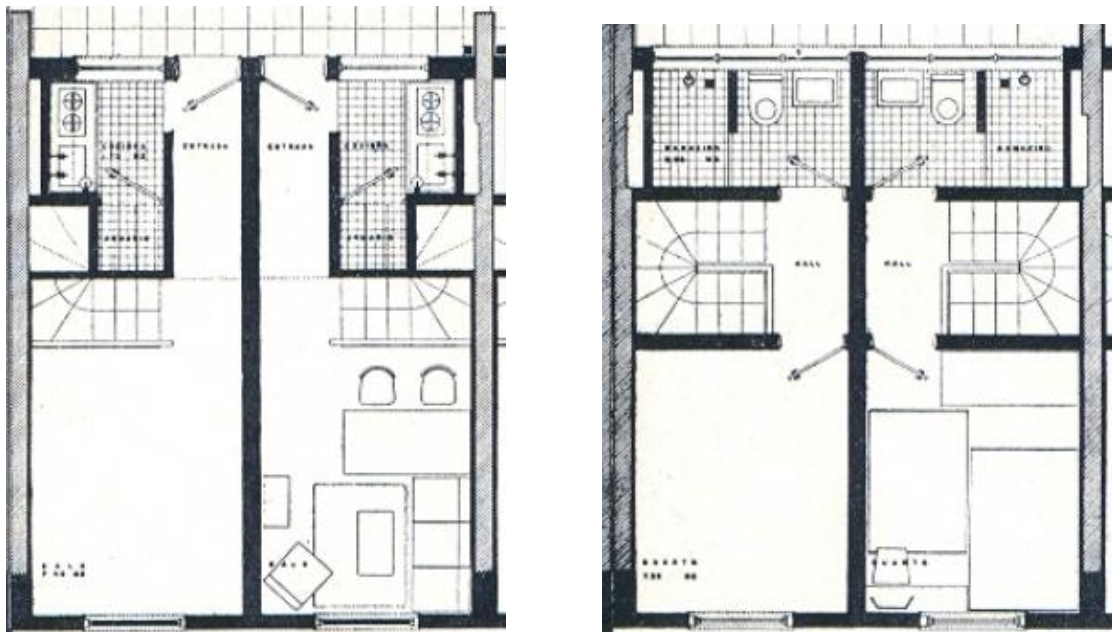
planta baixa do 1º e 2º pavimentos da tipologia duplex
